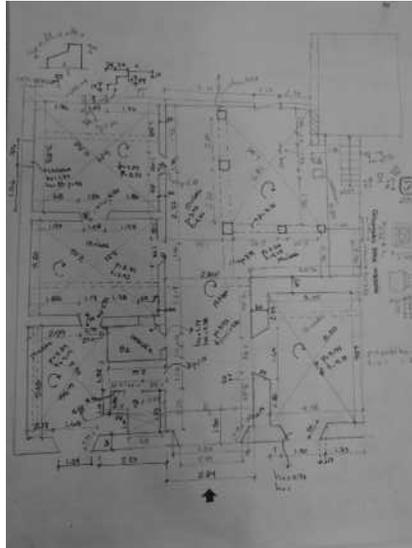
y 45. Levantamiento arquitectónico en interiores y levantamiento de fachadas respectivamente.
